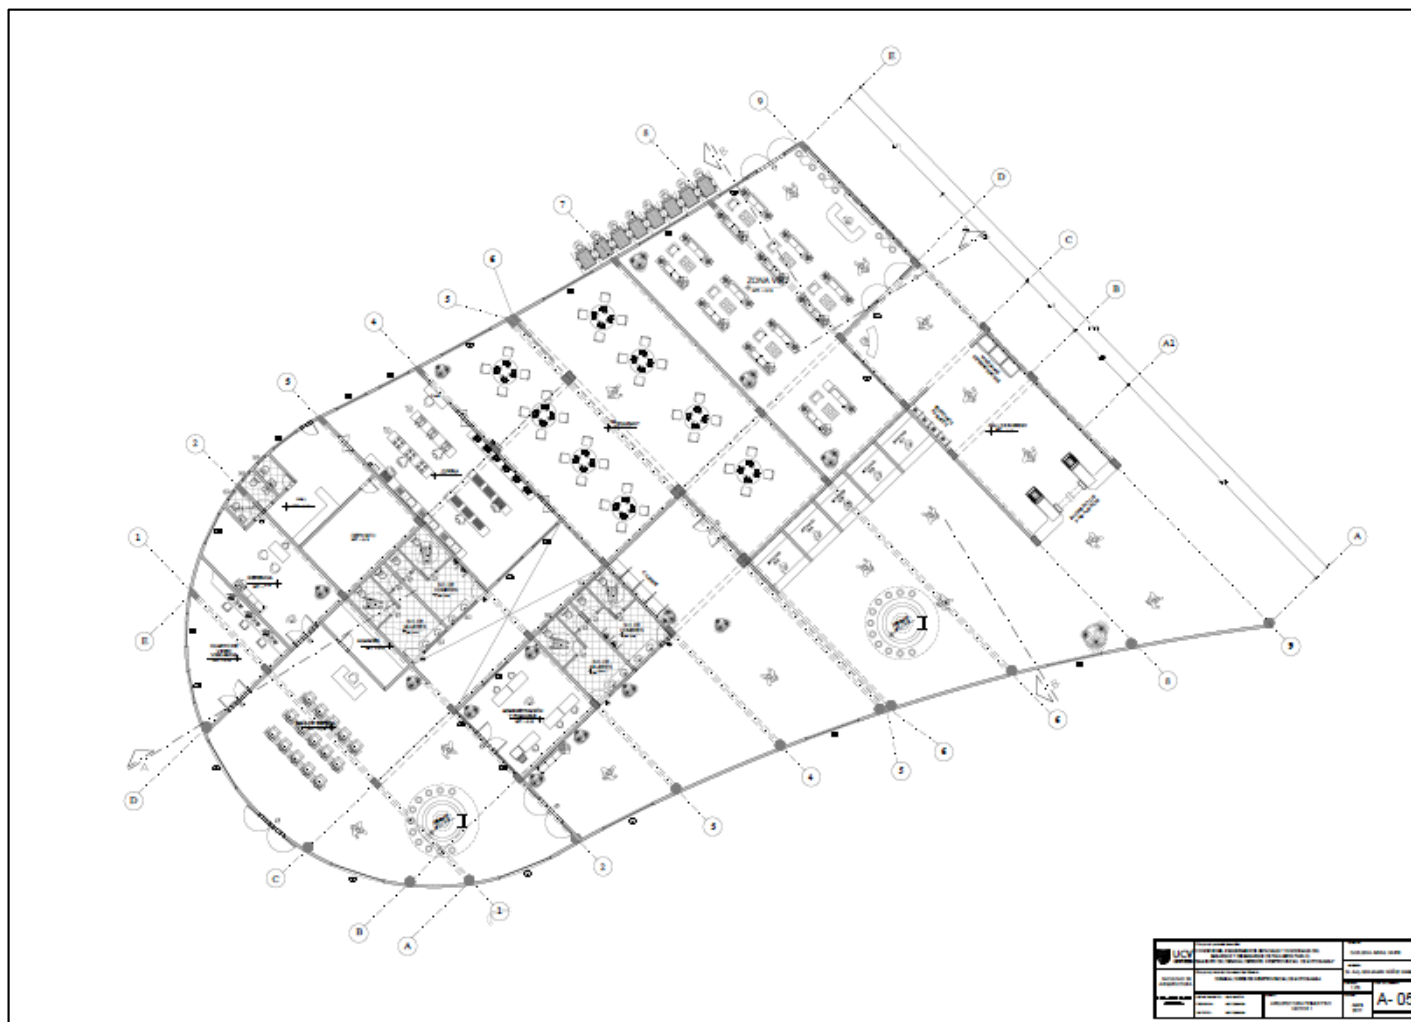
Plano bloque 1, Fuente: Elaboración propia.
